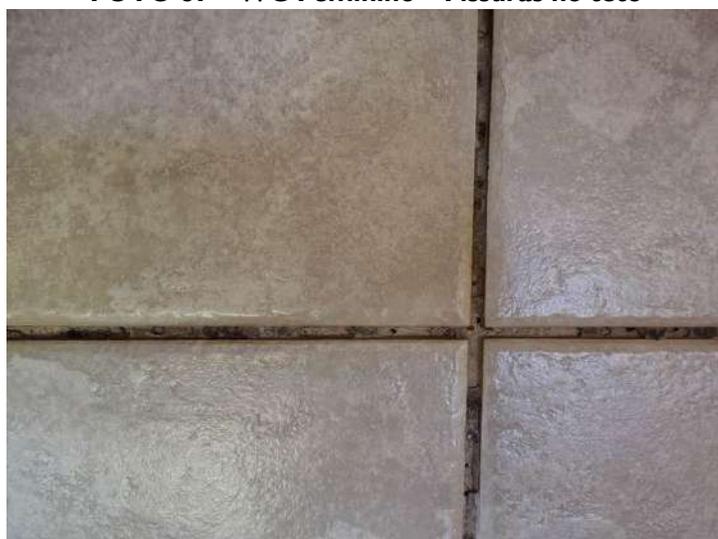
WC Feminino – Deterioração do rejuntamento do piso
